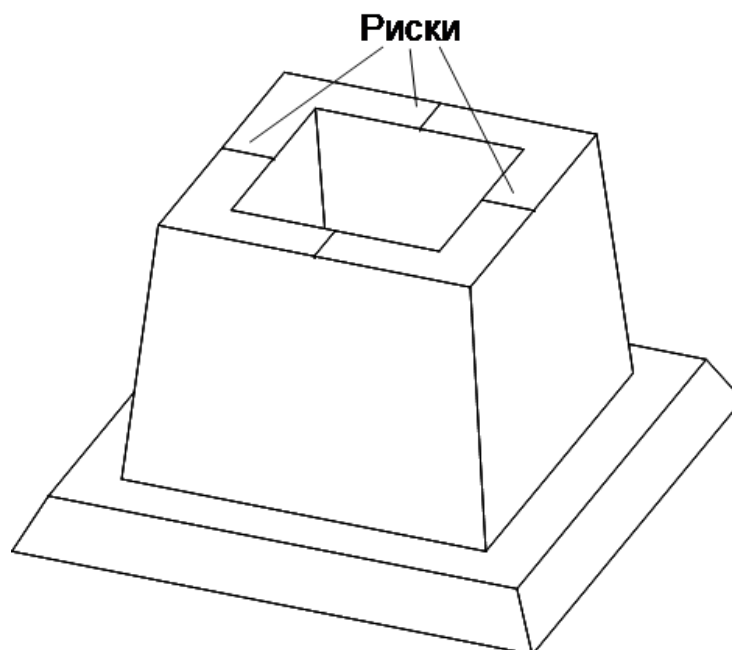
Бетонный стакан с нанесёнными рисками
